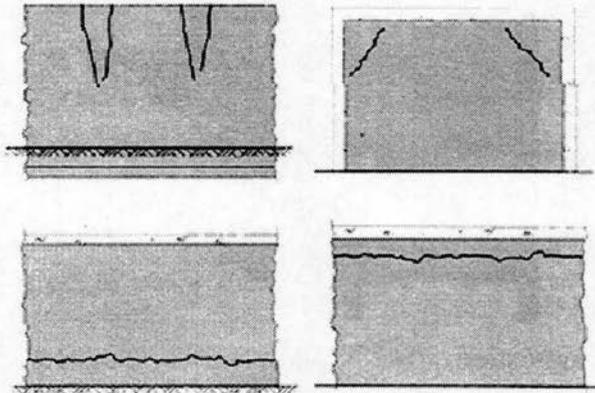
Fisuras de contracción hidráulica y térmica
